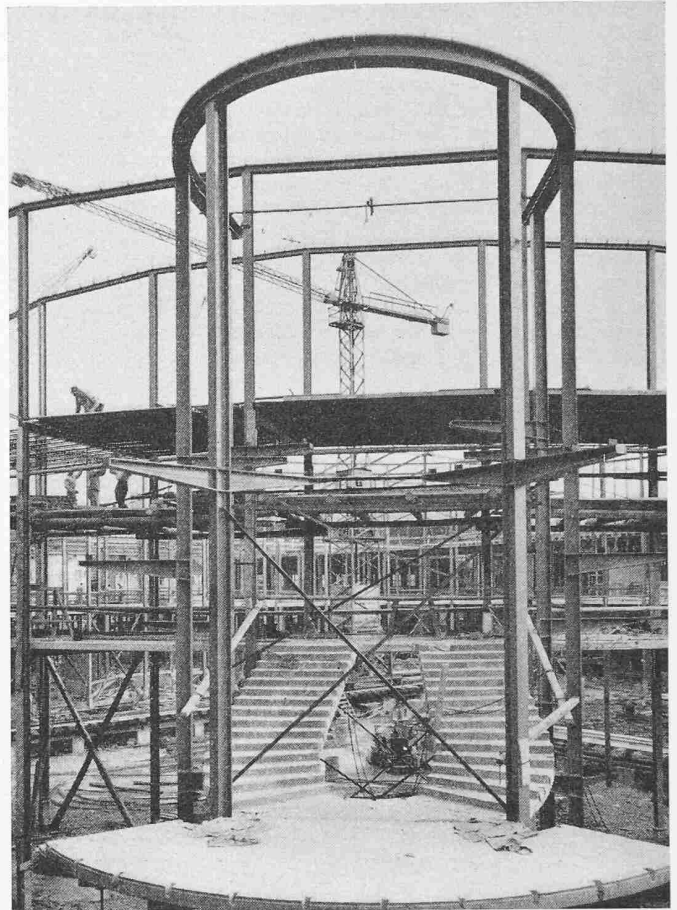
Hofgalerie und Hoftreppe im Bau, Decke über Erdgeschoss fertig, Galerie geschalt
